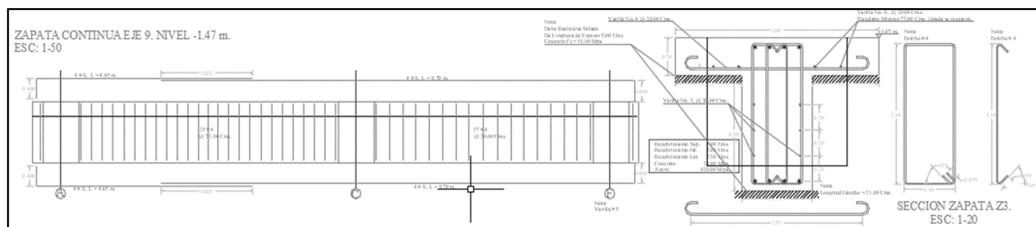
, despiece de acero de refuerzo, Viga eje 9, fuente constructora Open House
